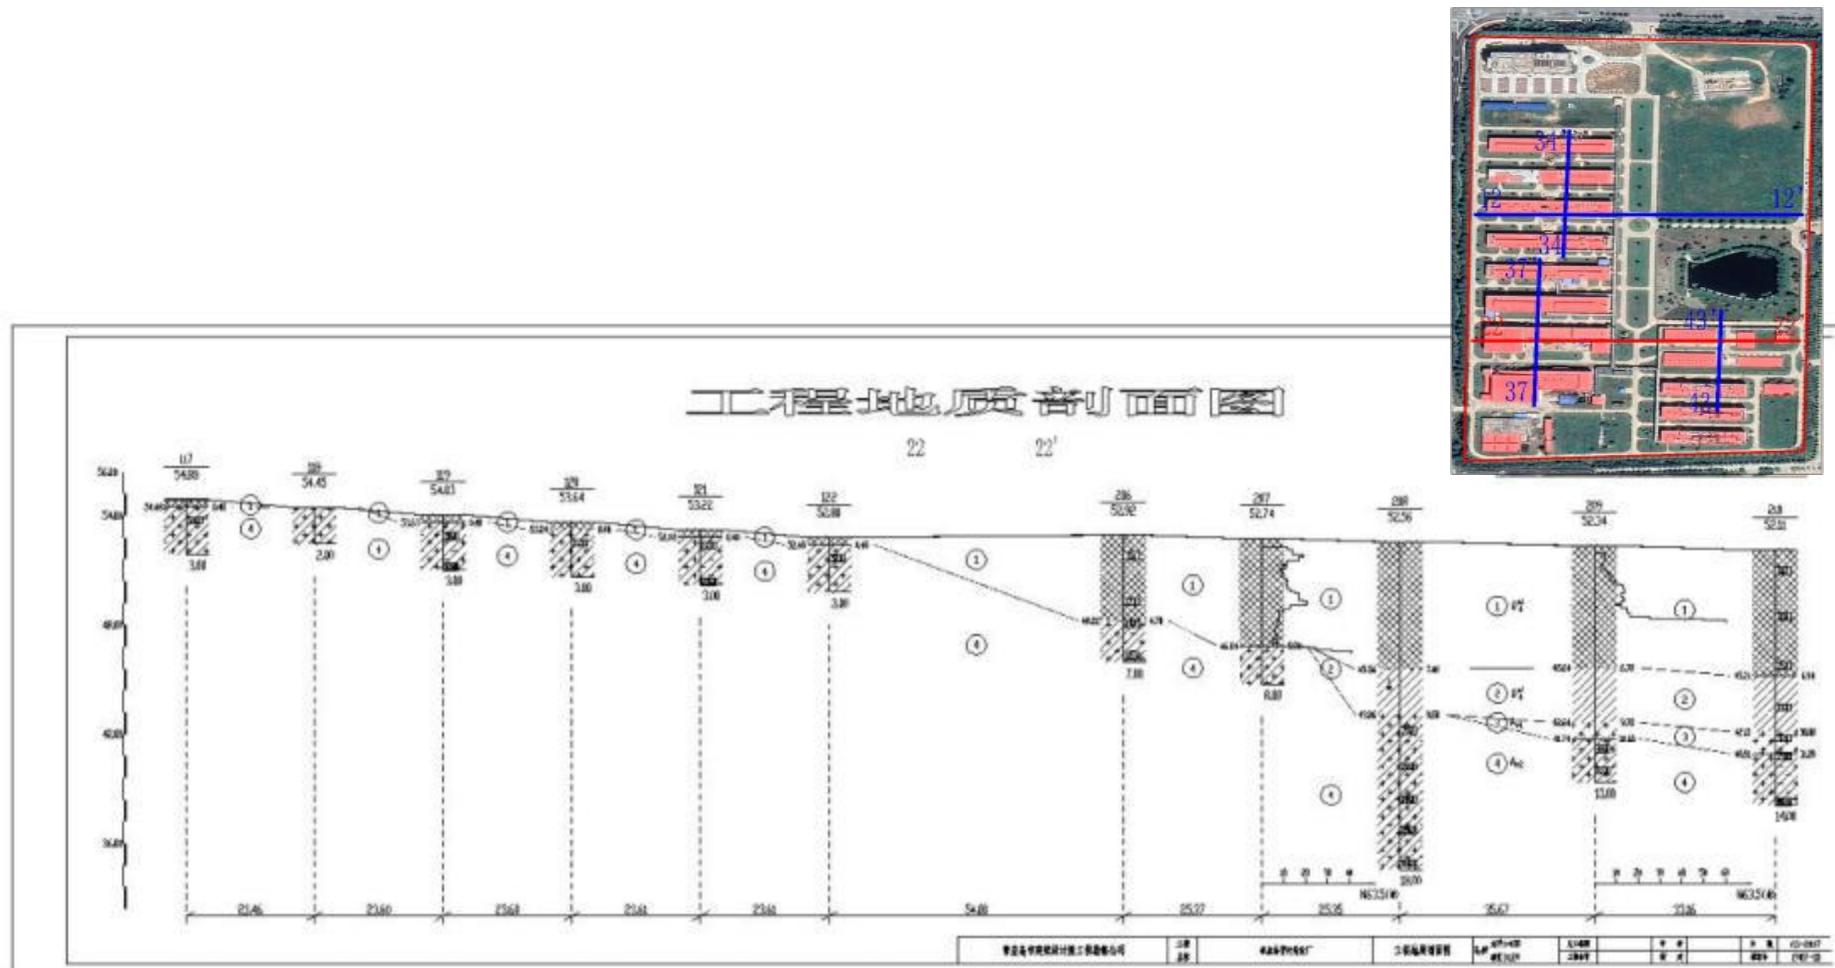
岩土工程勘察报告地层剖面图 东西方向 (2)
